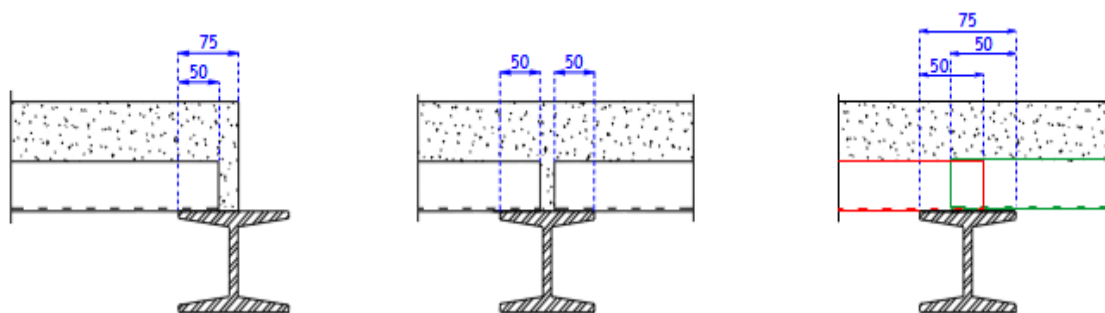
Distâncias mínimas [mm] de apoio da chapa em vigas metálicas.
